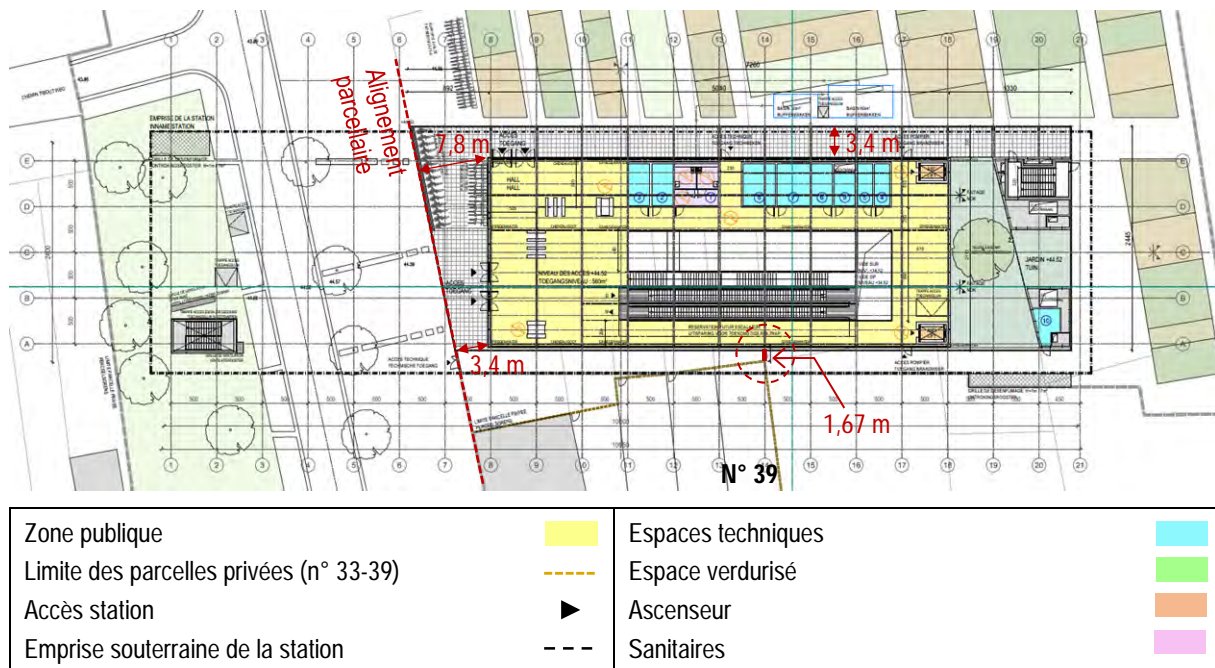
Plan du rez-de-chaussée de la station (ARIES sur fond BMN, 2017)
